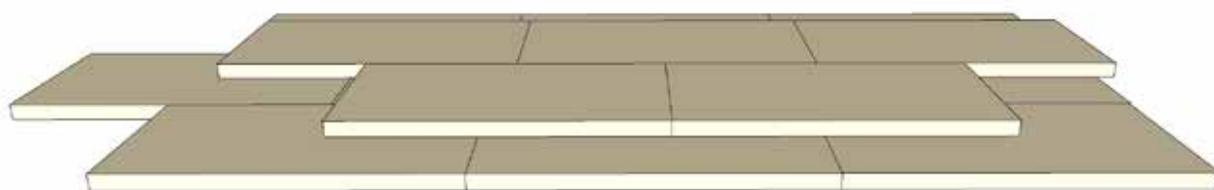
Toiture-terrasse - Isolant XPS - Pose en deux lits - Vue en plan
